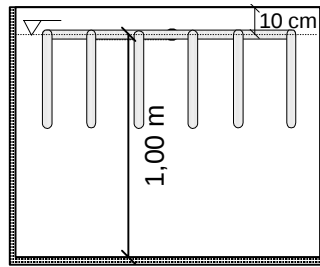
Lagoa 2 - corte AA da planta baixa
